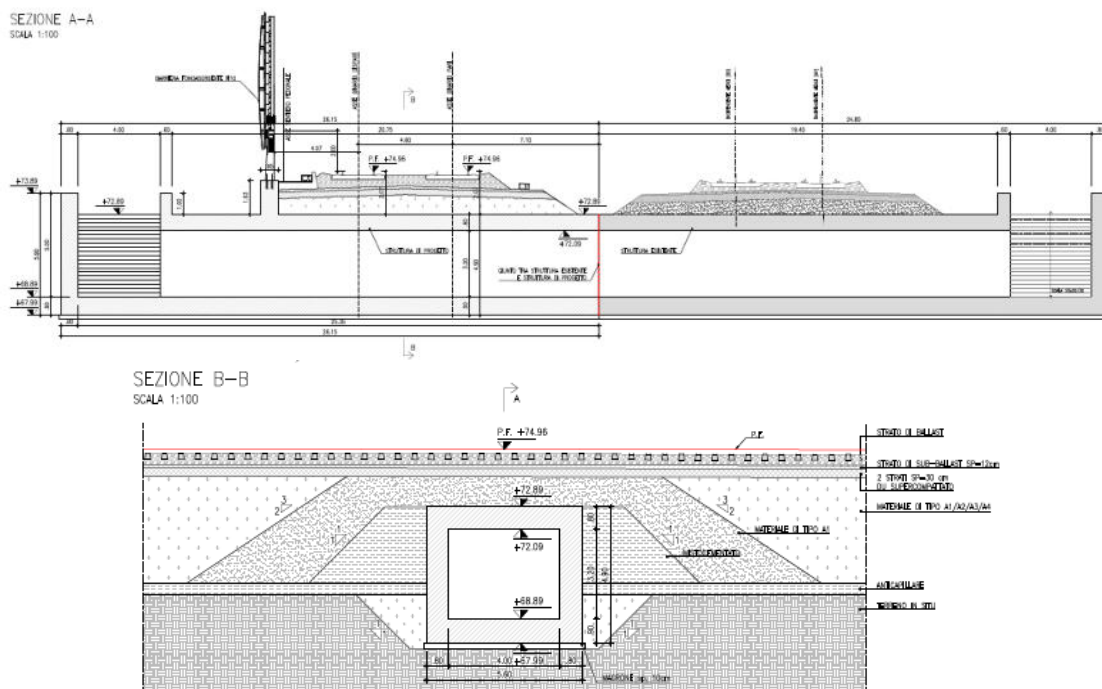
Sezioni longitudinali e trasversali sottopasso
